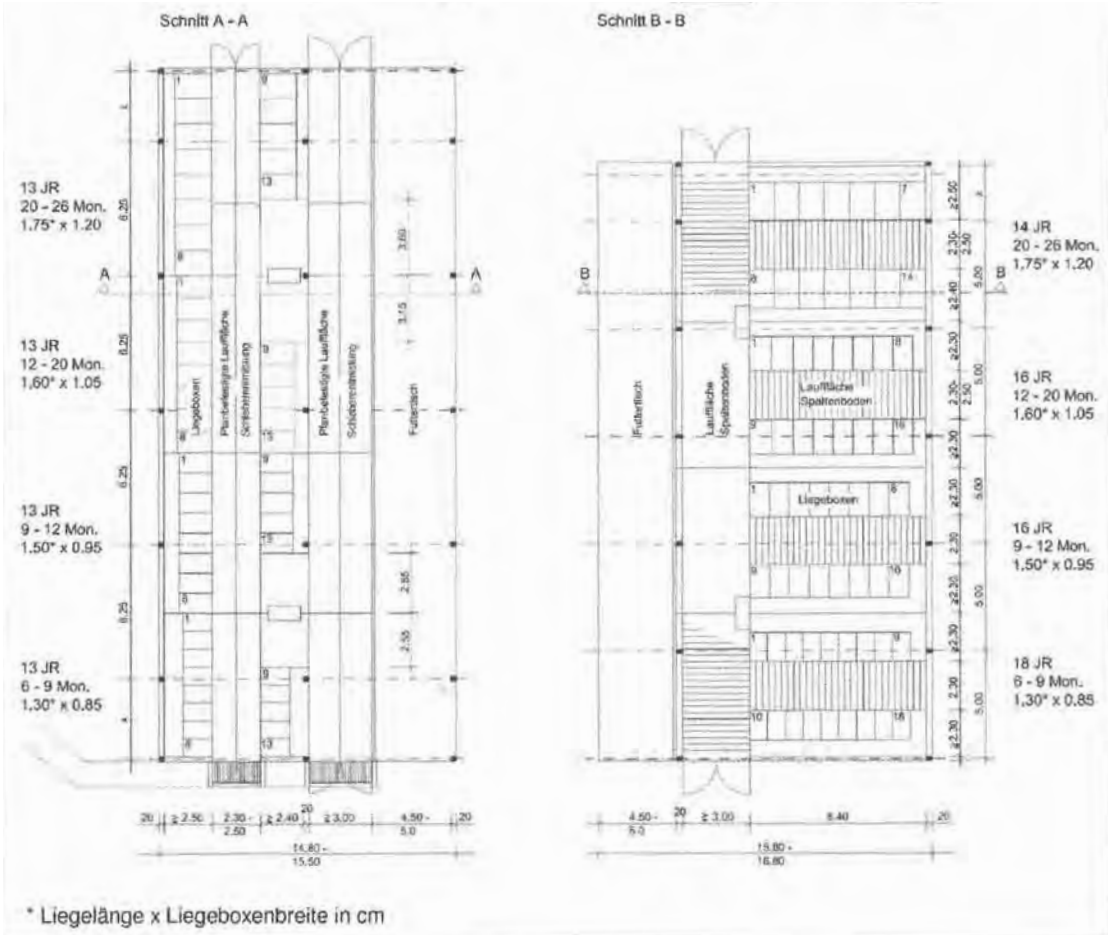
Plan eines 2-reihigen Boxenlaufstalls (links) und eines Kammstalls (rechts)
